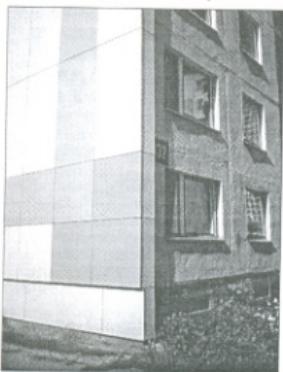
Реконструкция фасада жилого дома в Бильбайе
